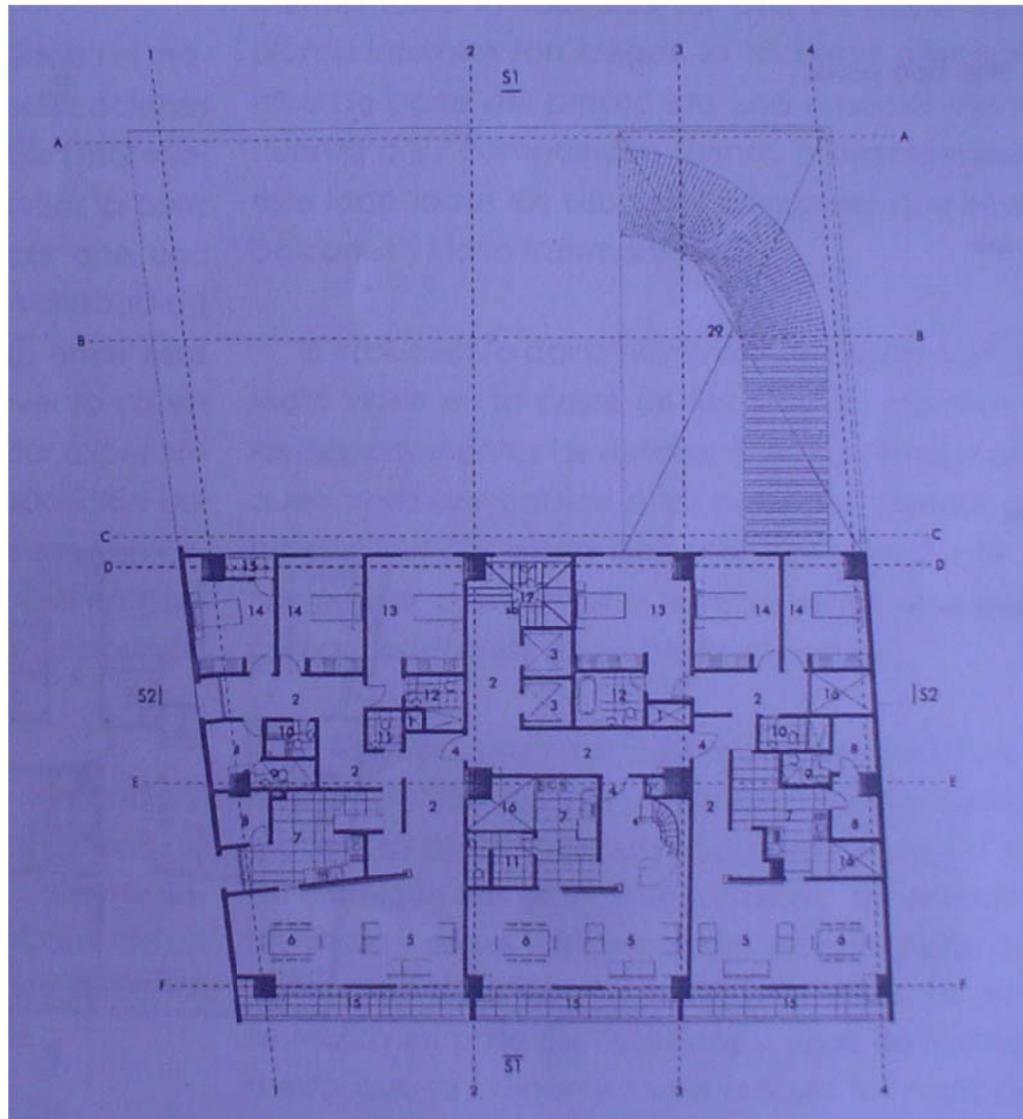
Primera planta tipo. Fuente: Tesis Lata Guamán, Oswaldo. ALAMIRO GONZÁLEZ. OBRAS Y PROYECTOS ENTRE 1960-1970
